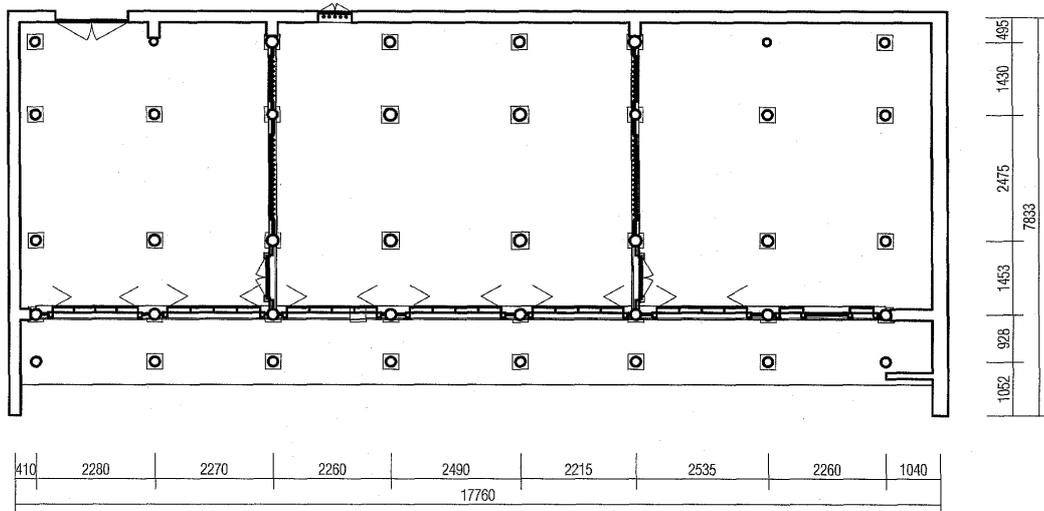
Ha Van Lam邸 主屋 平面图 1:150
